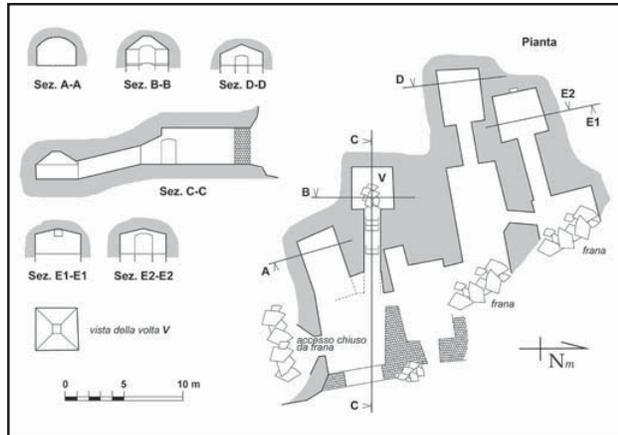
Planimetria e sezione dell'ipogeo n. 72 (Copyright CRSE).
